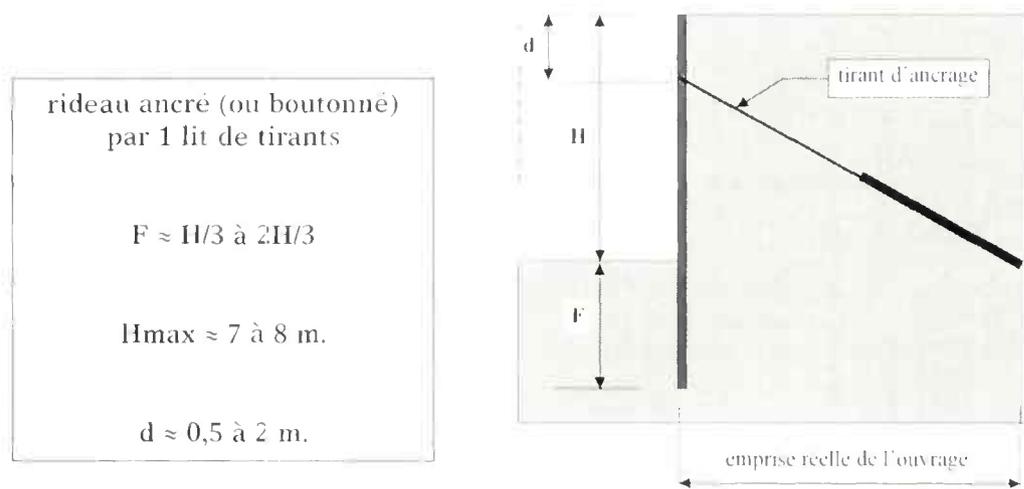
Dimensionnement courant d'un rideau ancré par un lit de tirants
